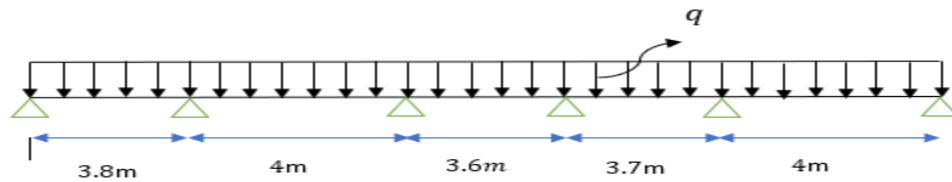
Schéma statique de la poutre appuyée sur 6 appuis.
